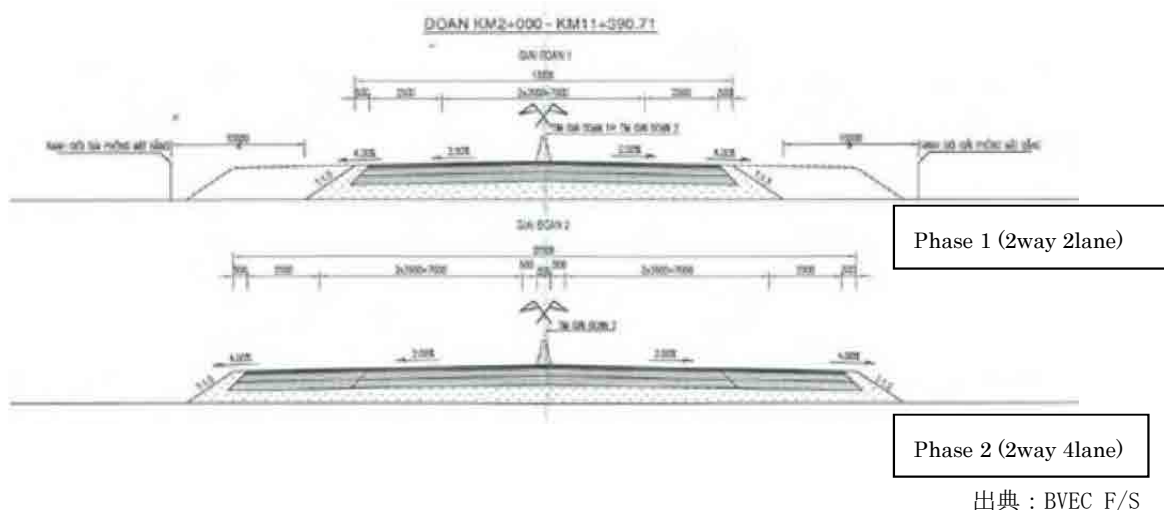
ビエンホア市バイパスの標準横断面図
